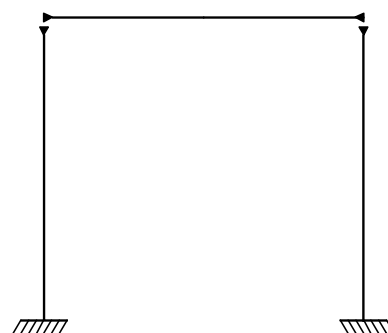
Pilar engastado na fundação e viga engastada nos pilares (apud EL DEBS, 1996).
